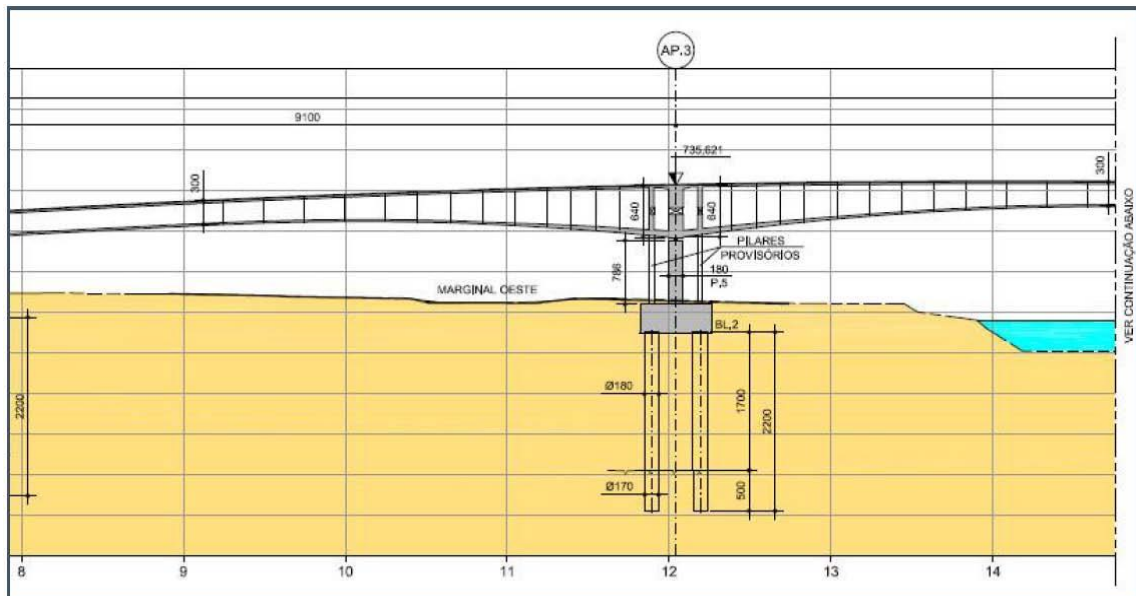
Perfil longitudinal da OAE – pista esquerda 2/4.
